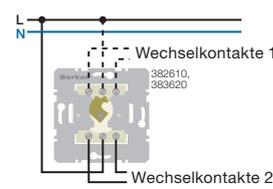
Wechselschalter 1- und 2-polig für Schließzylinder [Best.-Nr. 3826 10, 3836 20]
